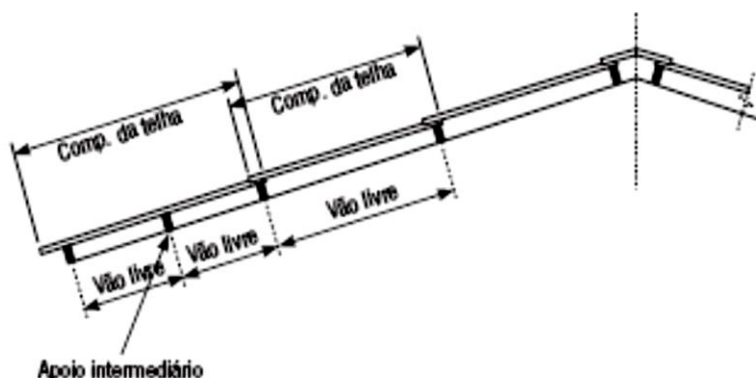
Exemplificação da colocação de apoios e vãos livres em telhas de fibrocimento
